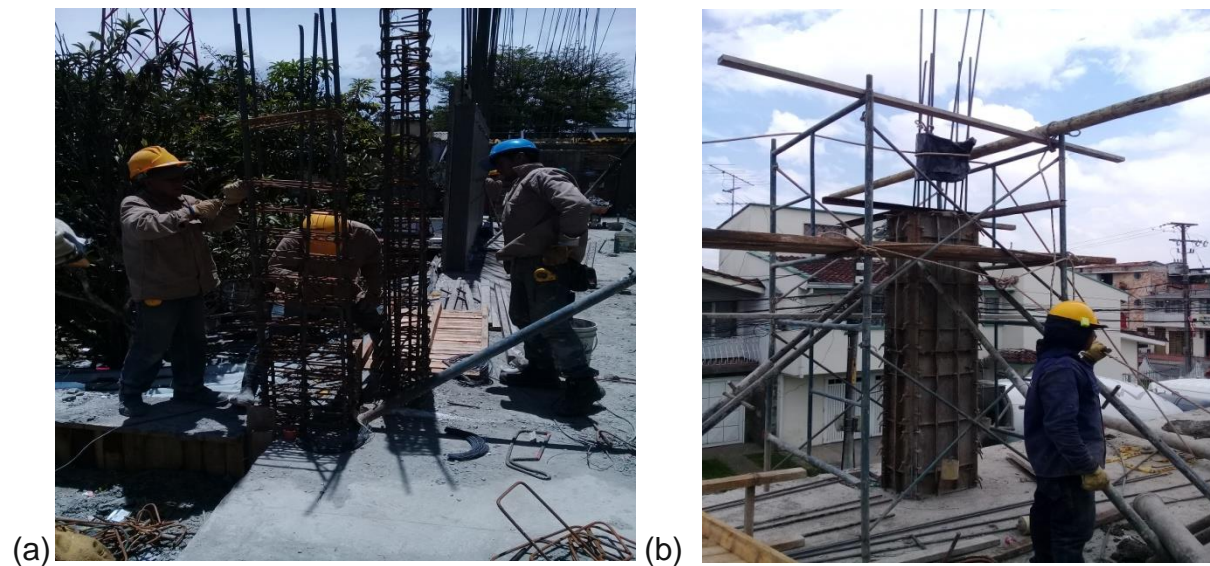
(a) Armadura de columna, (b) Formaleta y encofrado para columna. (Fuente: Autor).
